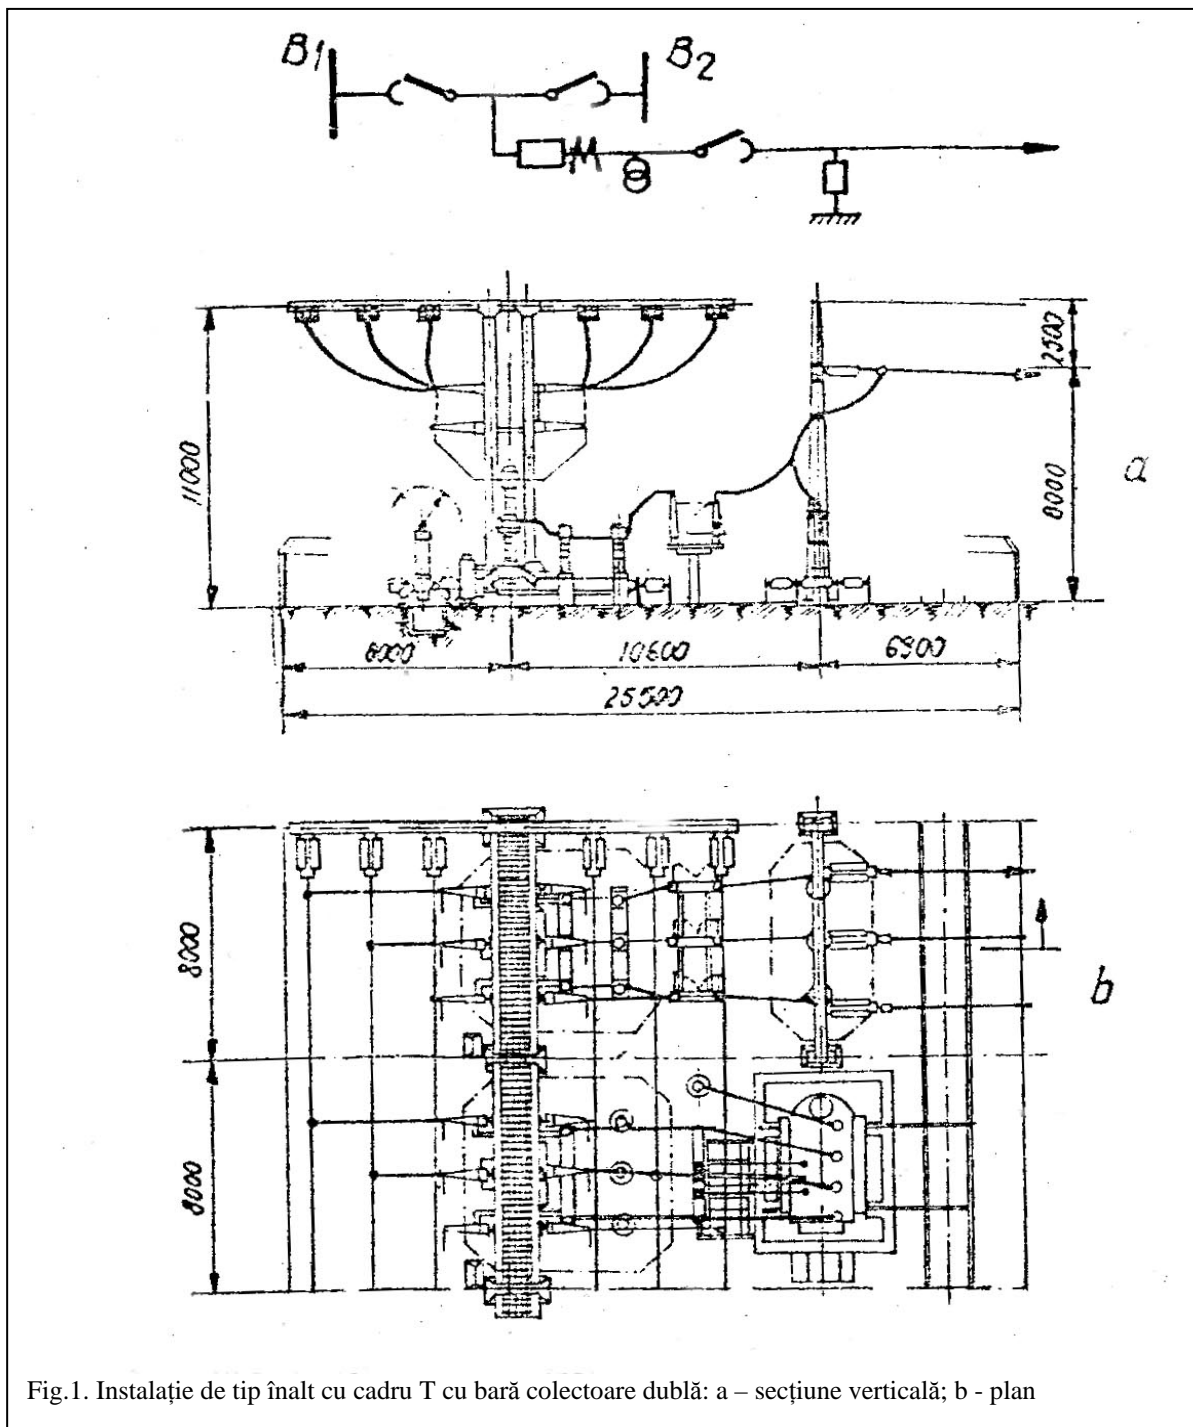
Instalație de tip înalt cu cadru T cu bară colectoare dublă: a – secțiune verticală; b - plan
